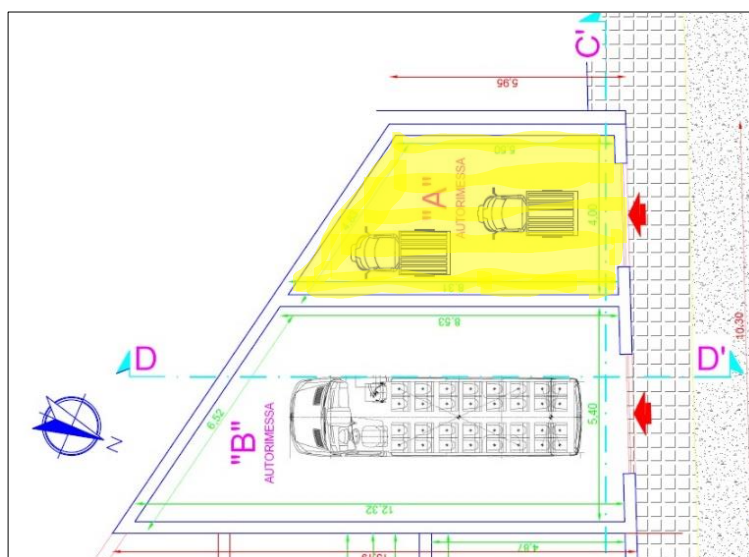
Nuovo corpo di fabbrica: nuova configurazione pianta in progetto
